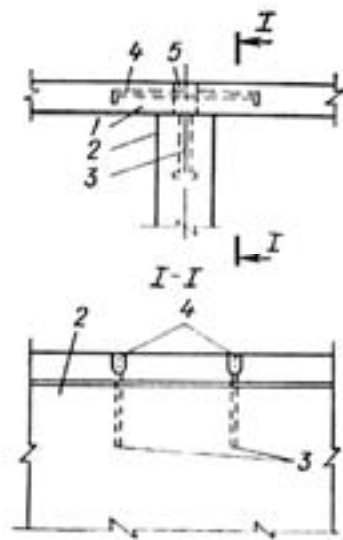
Улаштування анкерів між перекриттями і внутрішніми стінами: 1 – збірні елементи перекриття; 2 – внутрішні стіни з кам'яних матеріалів; 3 – анкери, що випускаються із кладки у шви між елементами перекриття; 4 – арматурні стрижні, що укладаються у шви між збірними елементами; 5 – монолітний бетон.
